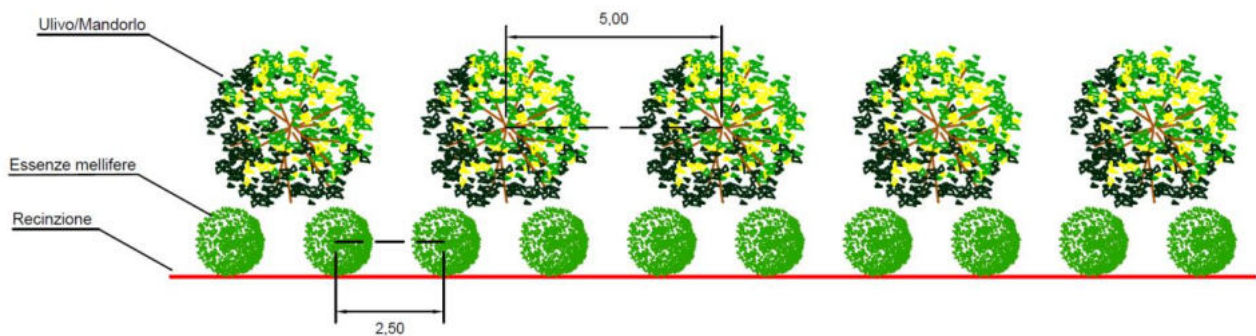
Fascia di mitigazione - schema in pianta del sesto di impianto
